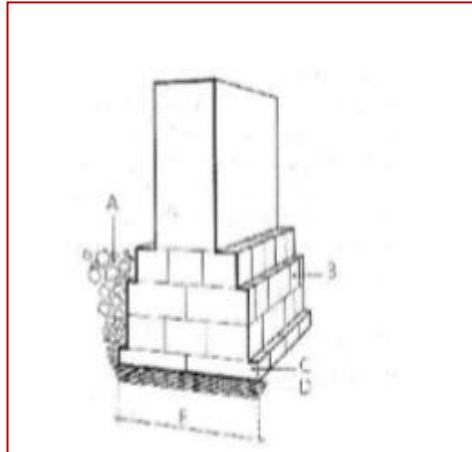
Fondation exceptionnelle en pierre sur un bon sol
